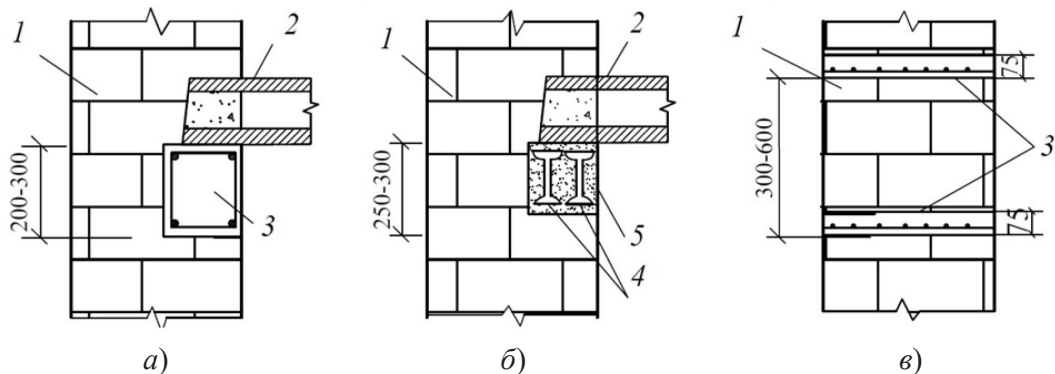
Усиление стен поясами жесткости: а – железобетонный пояс; б – армированный шов; в – армокирпичный пояс; 1 – надстраиваемая кирпичная стена; 2 – перекрытие; 3 – железобетонный пояс; 4 – металлические балки; 5 – бетон замоноличивания
